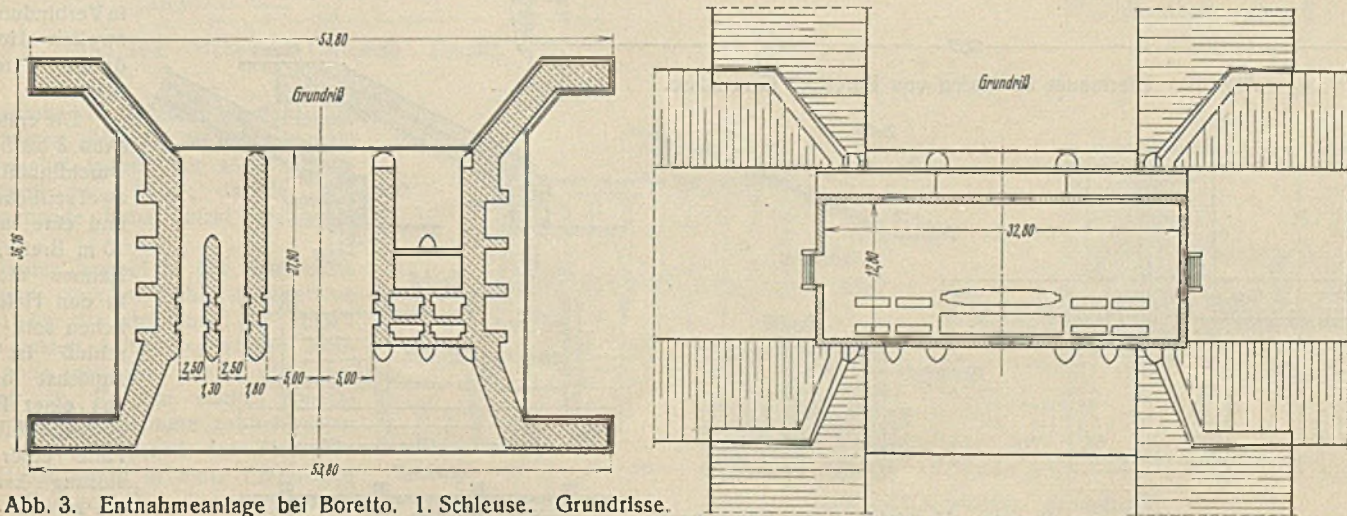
Entnahmeanlage bei Boretto. 1. Schleuse. Grundrisse.
